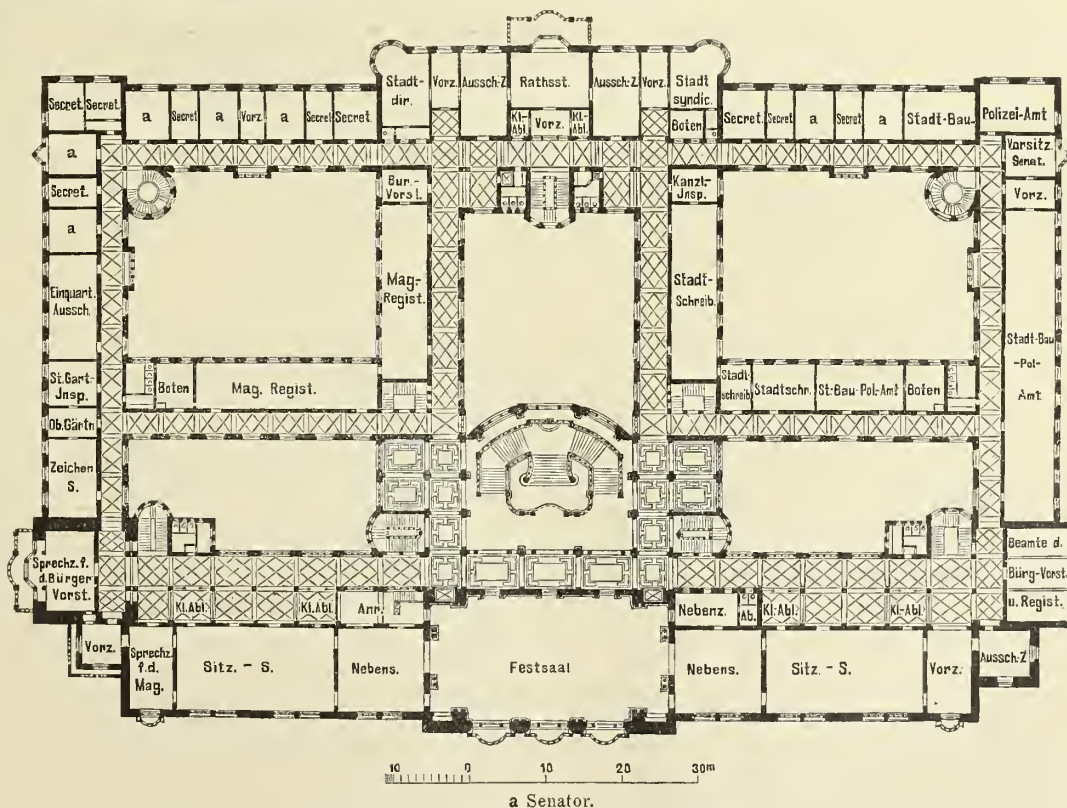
Grundriss vom 1. Obergeschoß.
